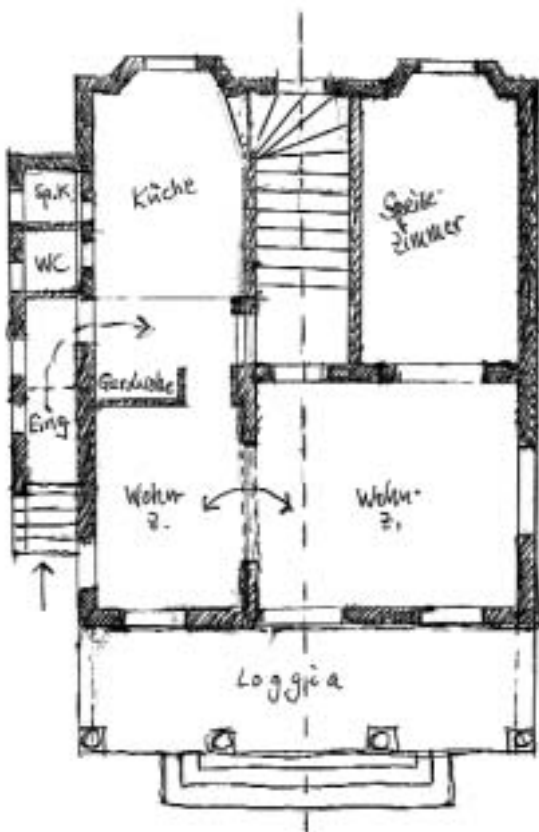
b: EG-Grundriss des Landhauses
